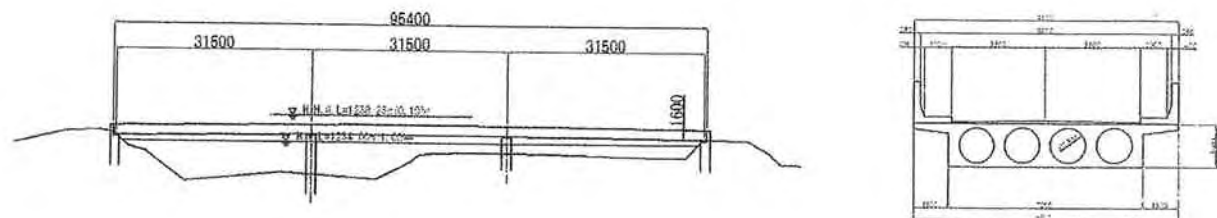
Plan du Pont dalles évidées continues en béton précontraint (longueur de travée : 31,5 m)
